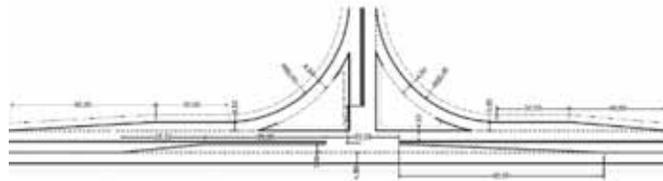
Planimetría de intersección canalizada recta tipo adoptada
